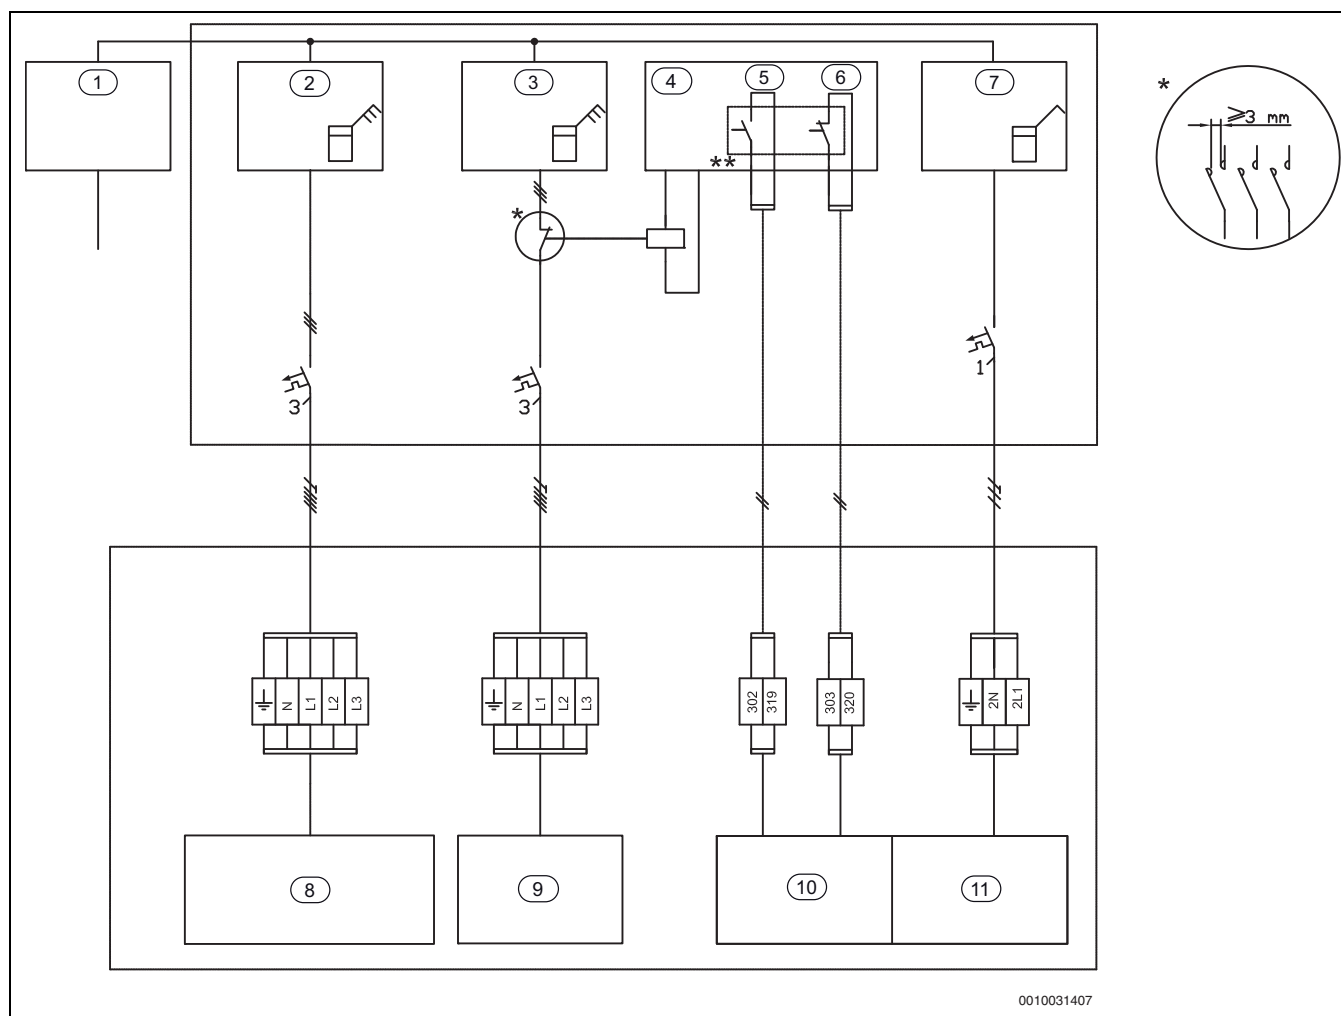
EVU-type 3 med nedlukning af kompressor/dypevarmer
